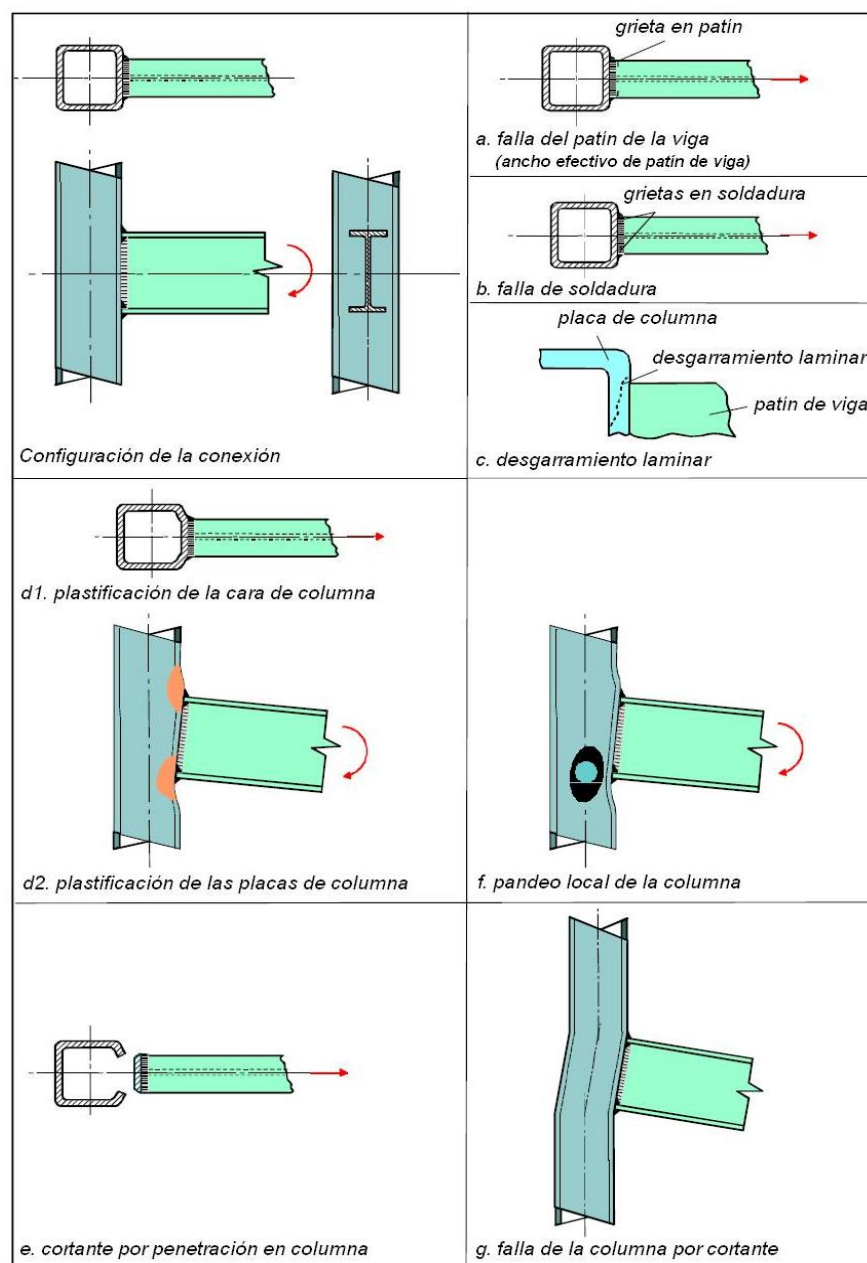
Modos de falla de conexiones de vigas de sección I con columnas HSS
